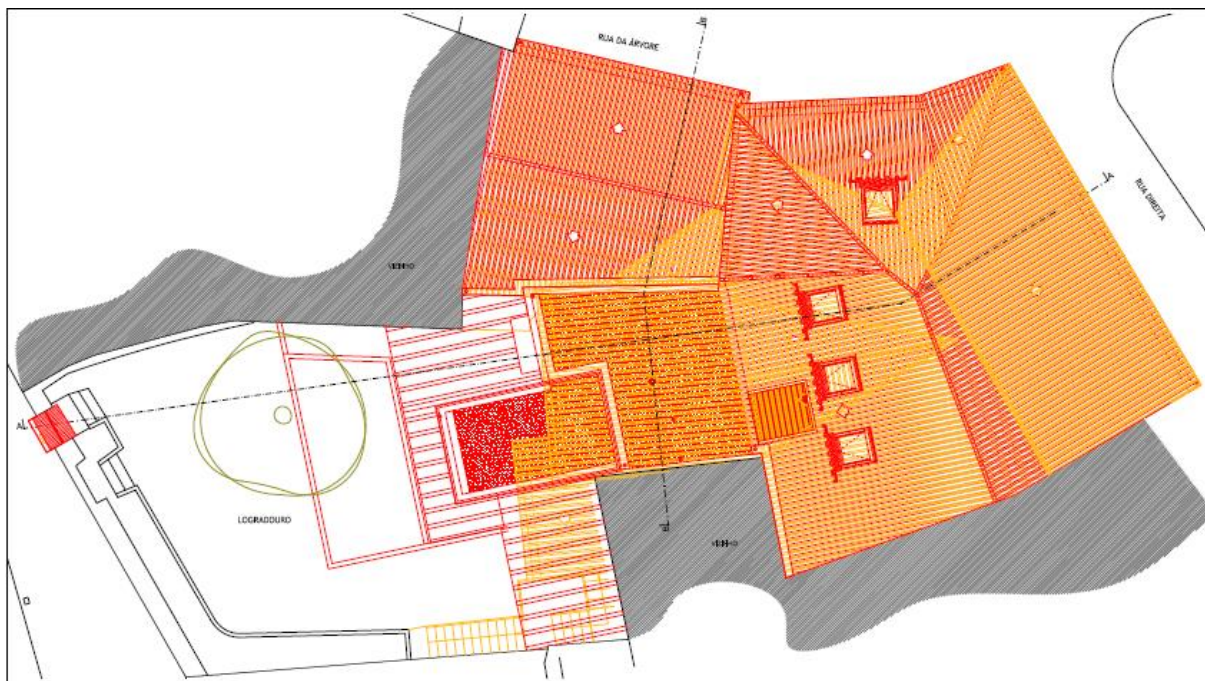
Planta do Piso 2 do edifício 3 em estudo
